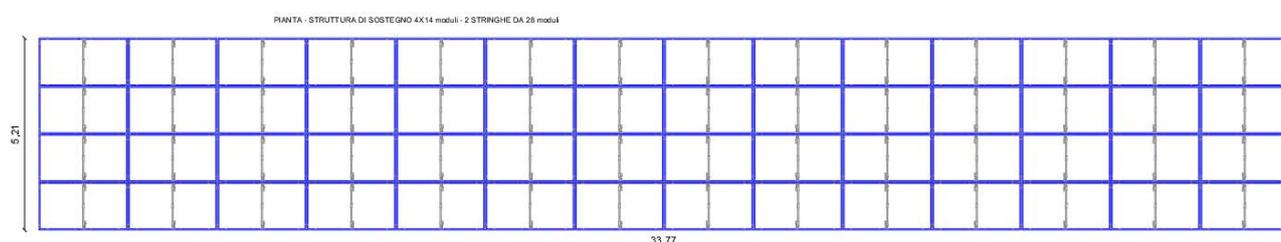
Struttura di sostegno 4x14 moduli- 2 Stringhe - Pianta
